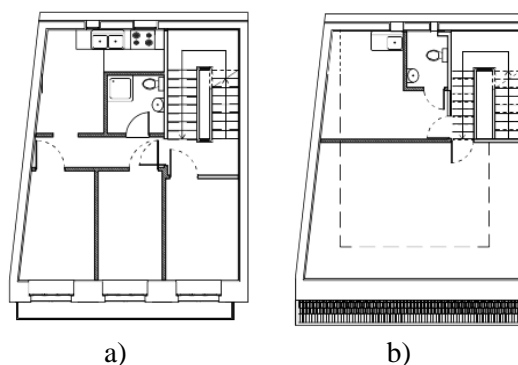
Plantas CAD do caso de estudo antes da intervenção. a) Planta do terceiro andar; b) planta das águas furtadas.
